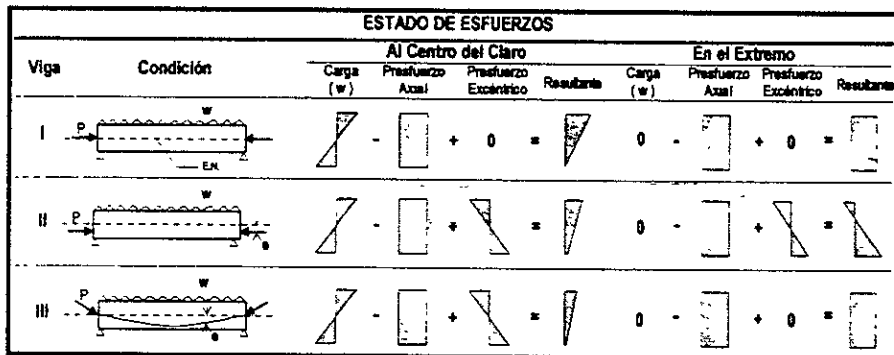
Estado de esfuerzos en el centro y extremo de una viga presforzada.
